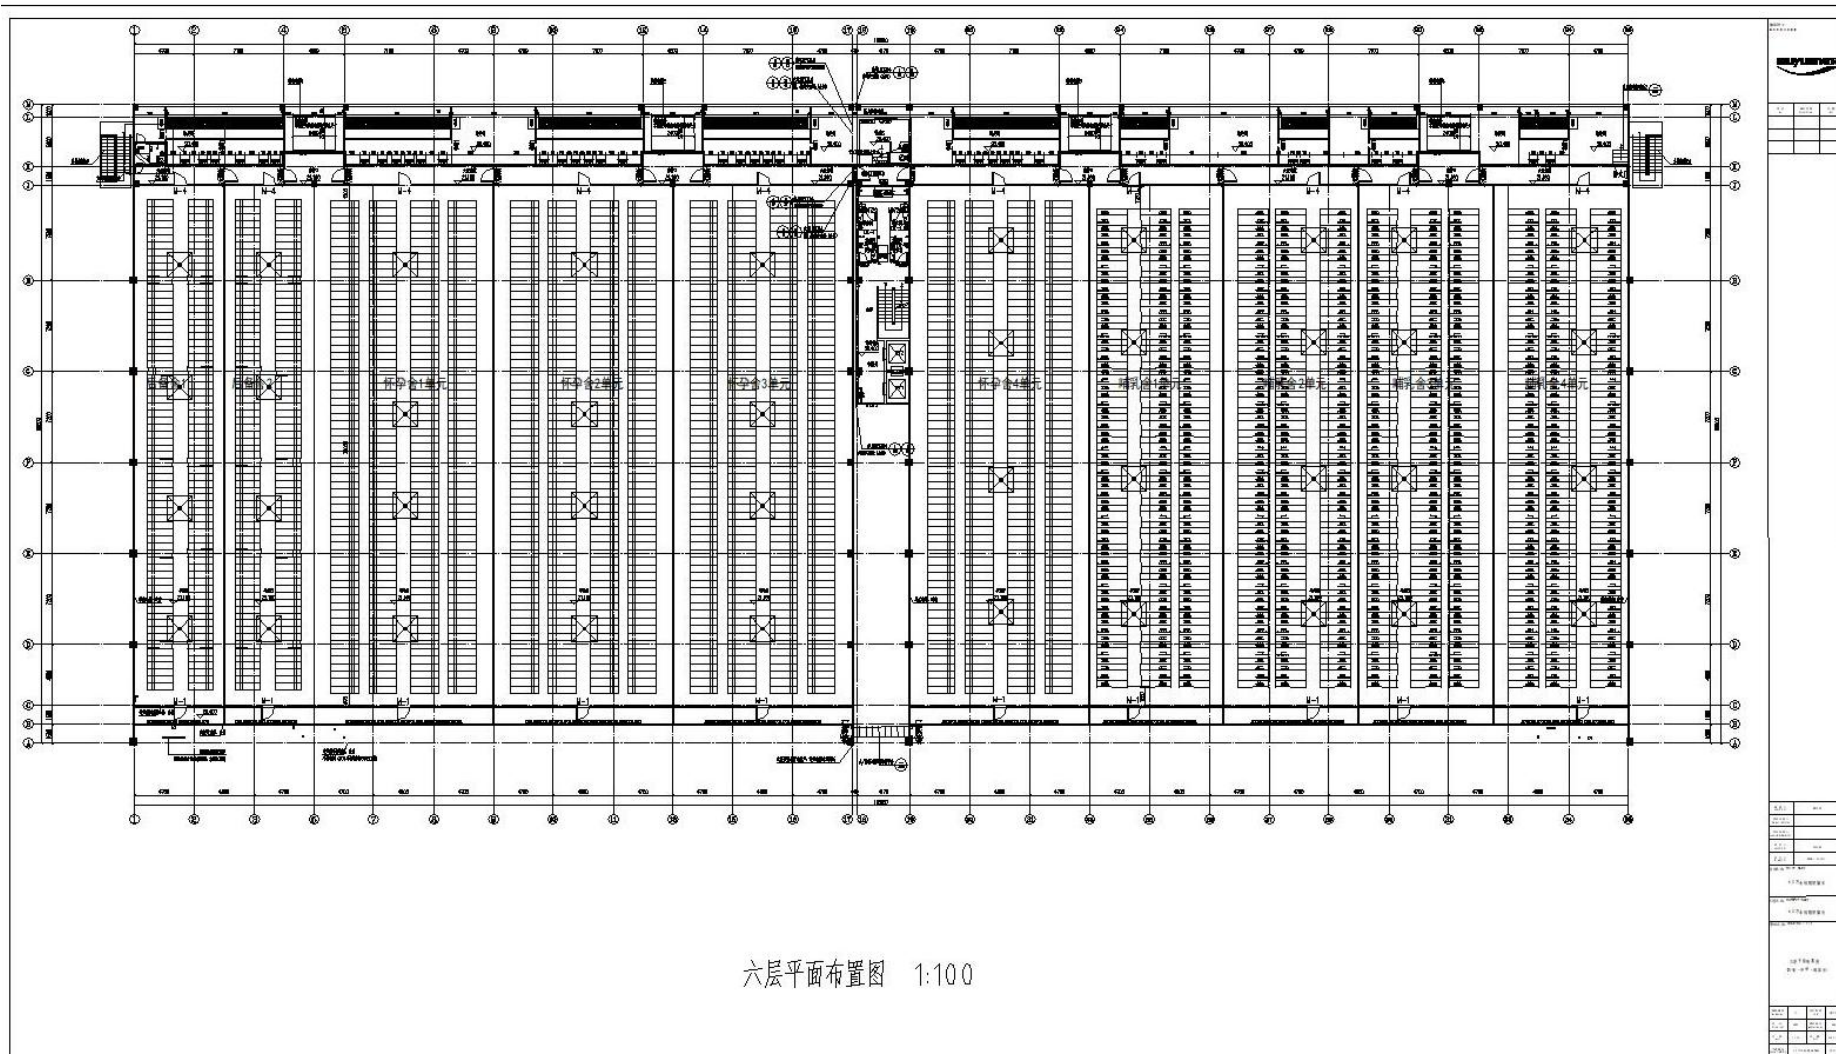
楼房猪舍（6层）平面布置示意图
